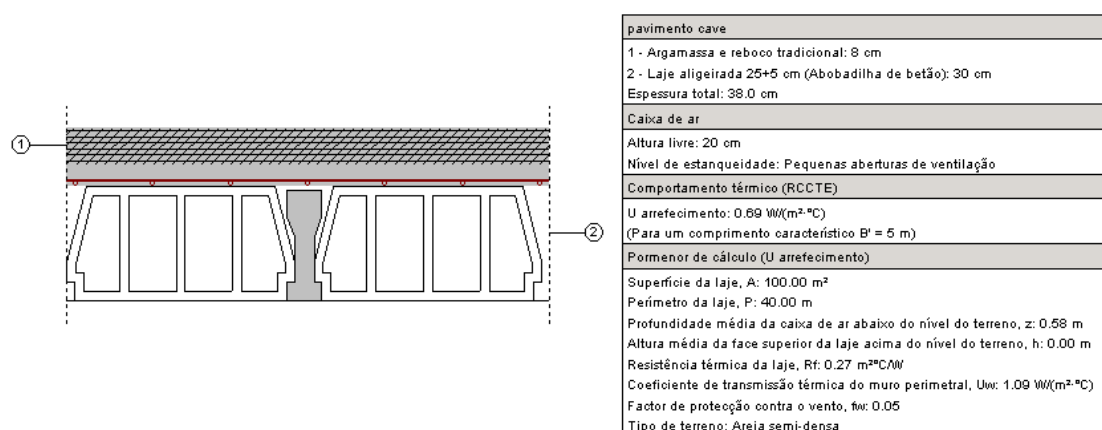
Constituição esquemática de pavimento térreo (software Cype).
